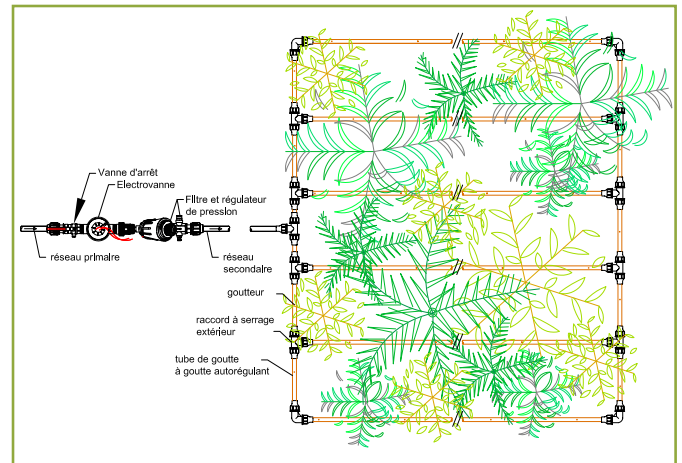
Installation type d'un goutte-à-goutte de surface, sur un terrain plat
